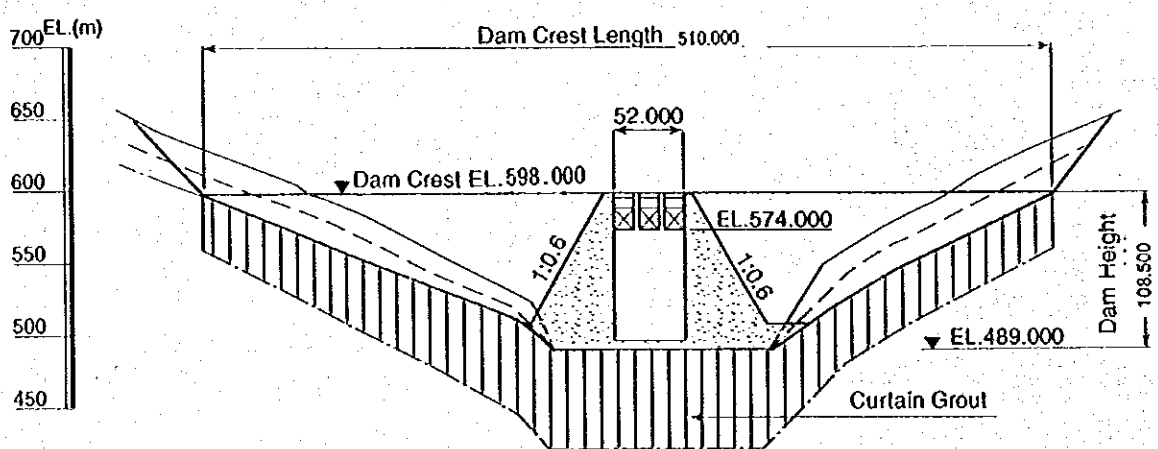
ドンナイ第4ダム型式に関わる代替案 (コンクリート重力式ダム)
